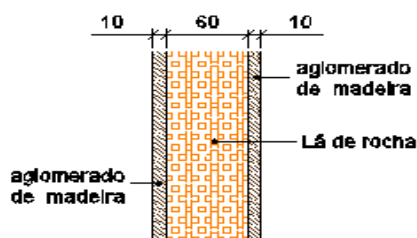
Pormenor das paredes da envolvente interior – PI4
